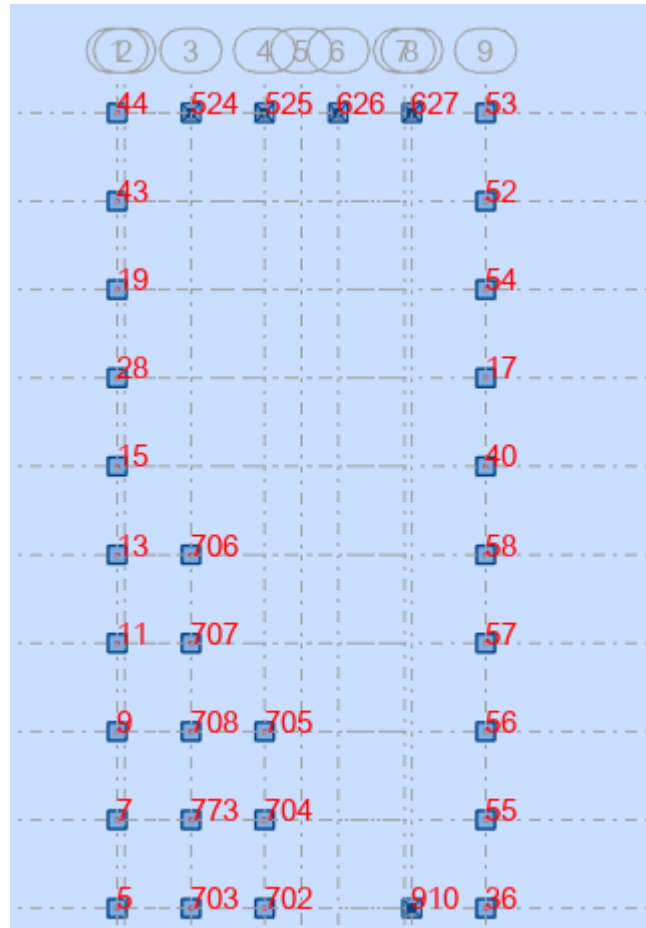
Implantation des nœuds de poteaux sur Robot
